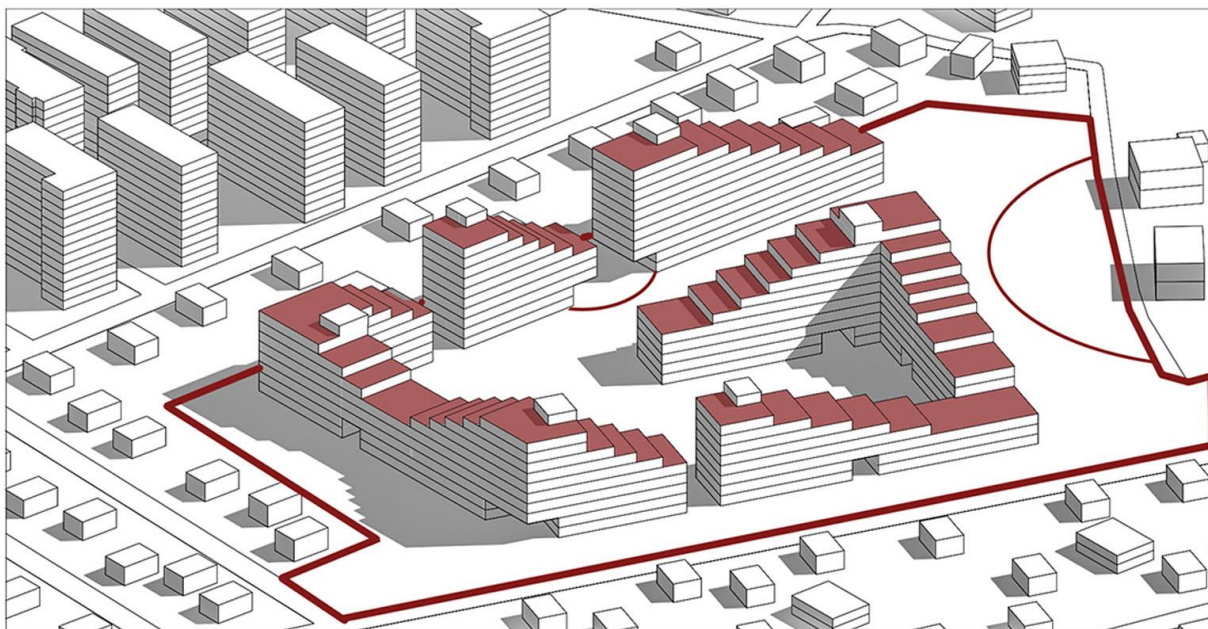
Об'ємно-планувальне рішення будівель.
